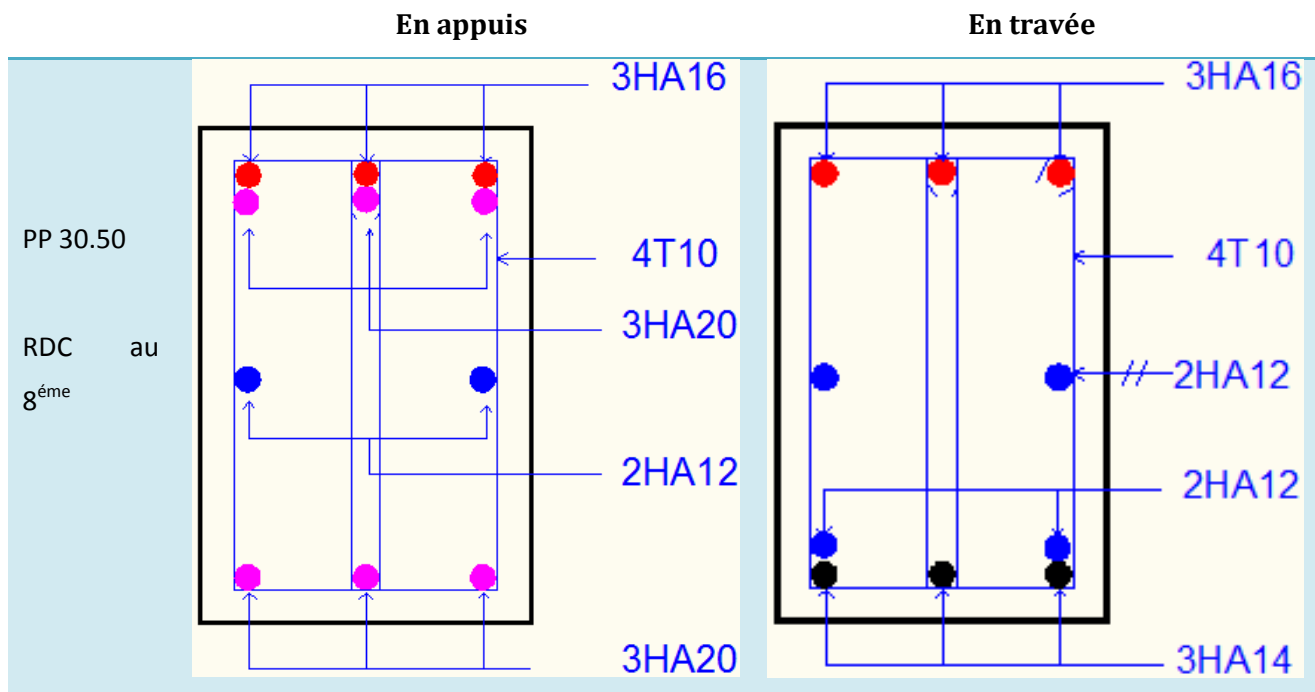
Section de ferrailage des poutres principale 30.50.
